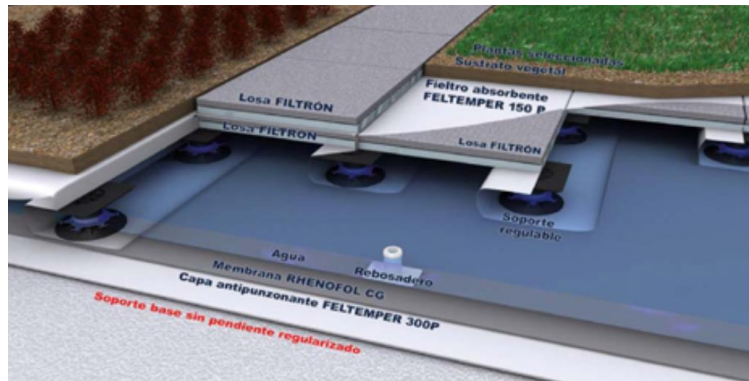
Detall en 3D del sistema constructiu actual, elaborat per la casa Intemper.
